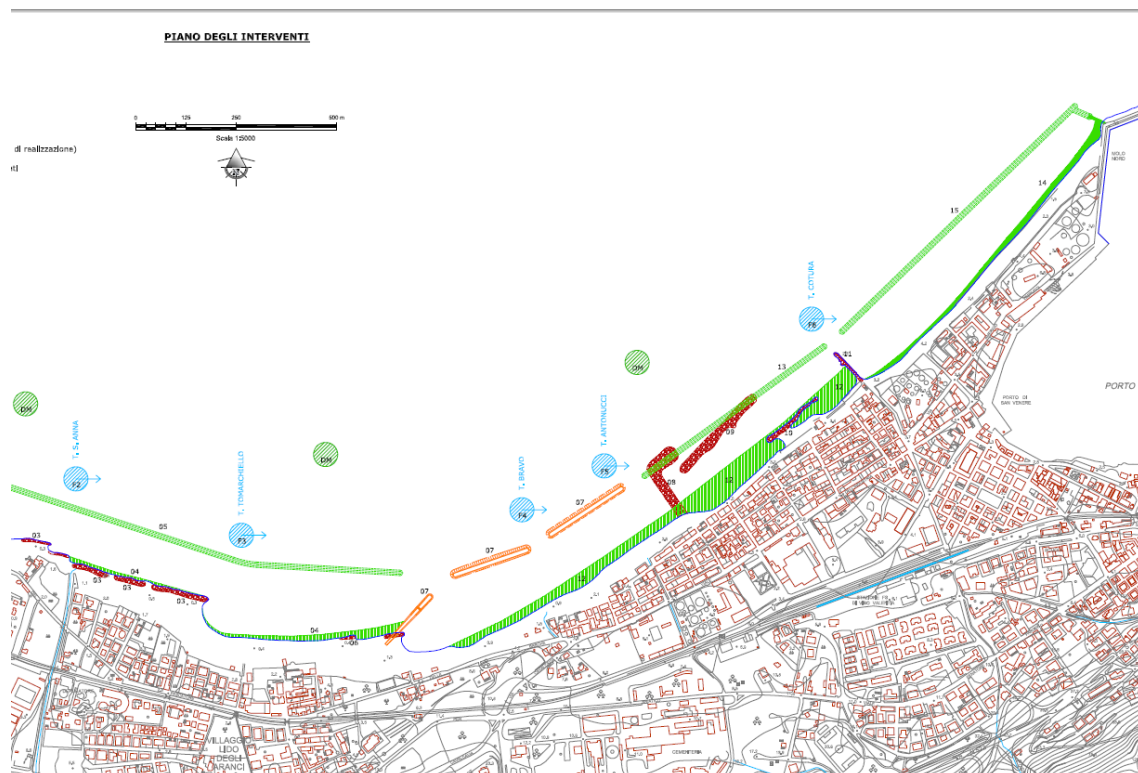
Interventi proposti dal Master Plan – Litorale Vibo Valentia
